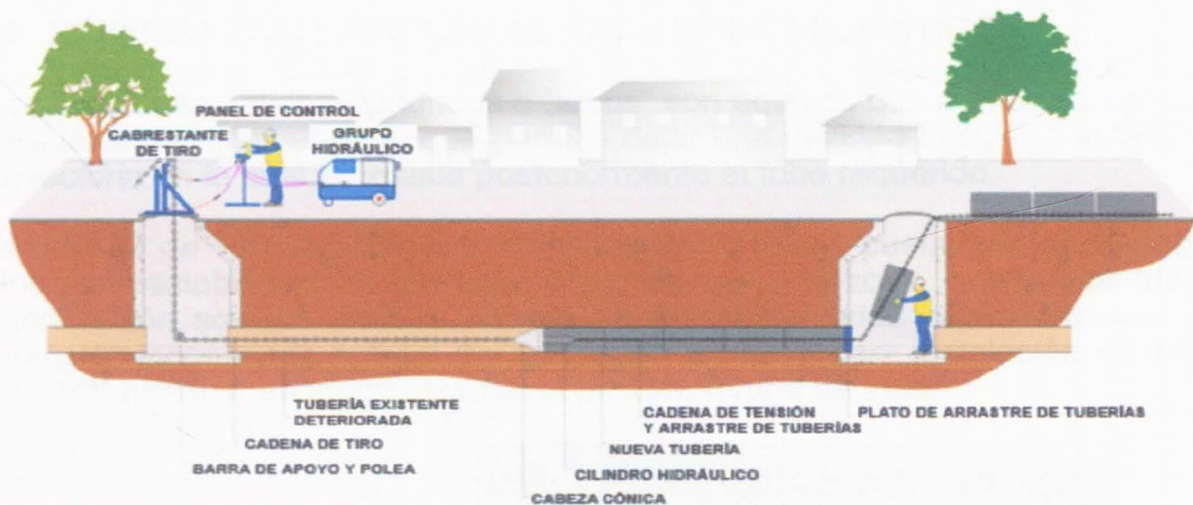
INSTALACIÓN SLIPLINING⁵
